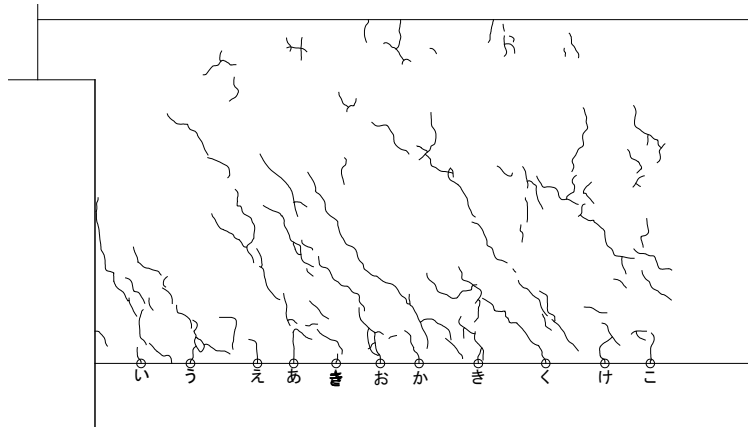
基礎梁ひび割れ幅測定位置(試験体 A-7a 正載荷)
